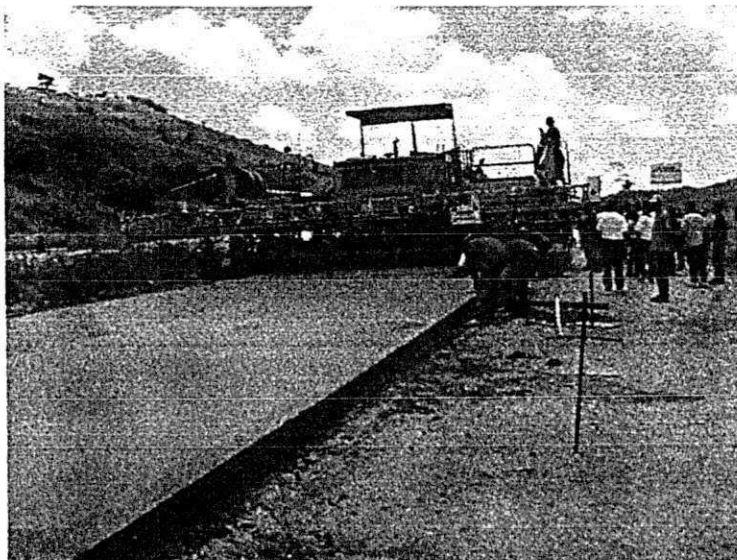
Detalhe da Pavimentadora modelo SF 3002
